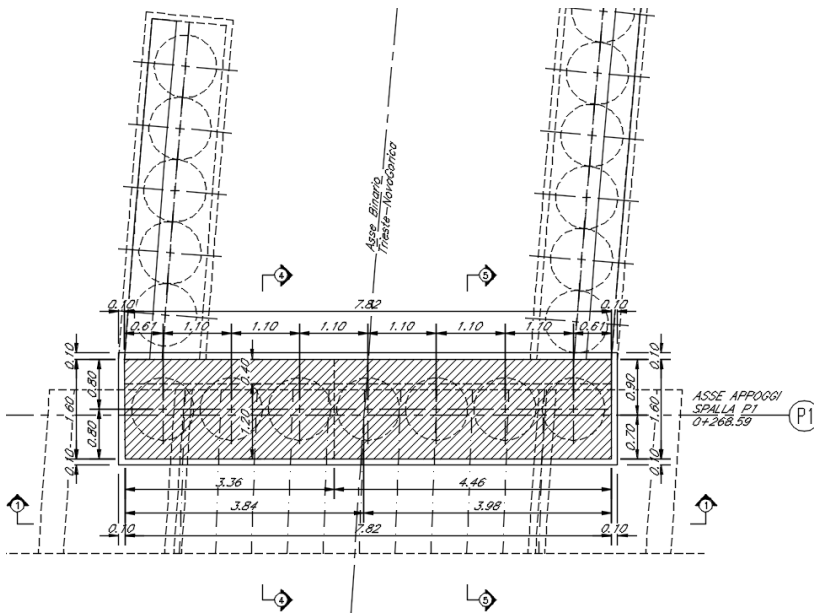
Spalla P1 - Sezione orizzontale 2-2 (sezione a quota fondazione)
